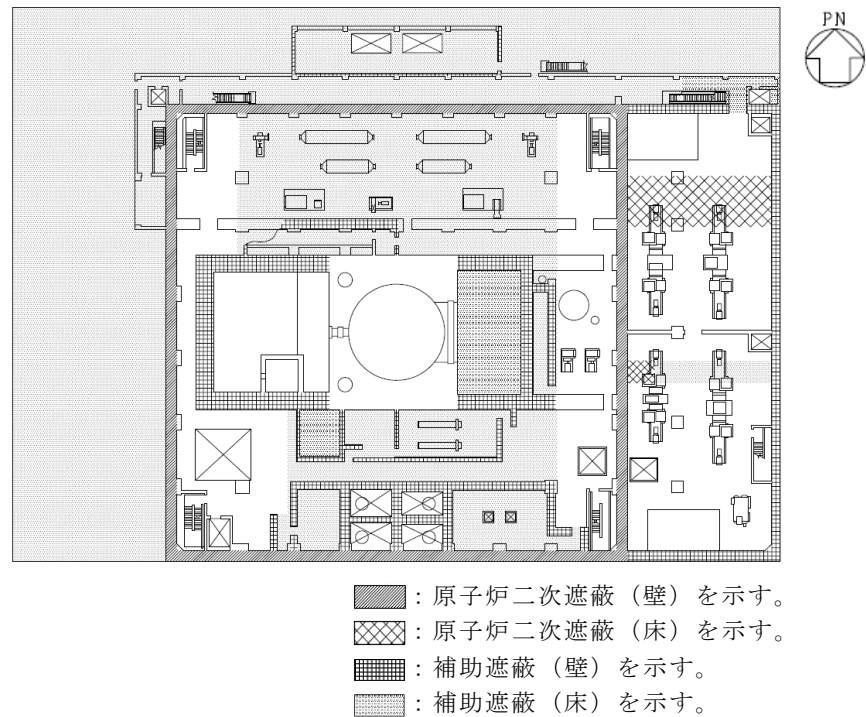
(8) 原子炉二次遮蔽及び補助遮蔽（原子炉建物）の範囲の平面図
